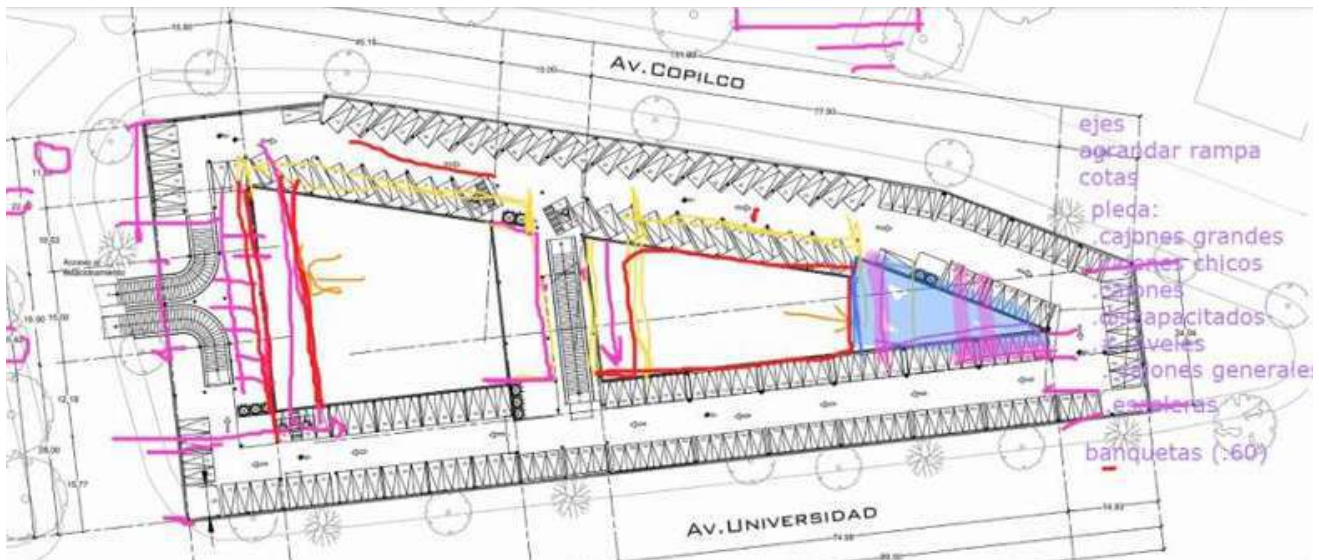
Propuesta de estacionamiento con correcciones. Fuente: Autoría propia
